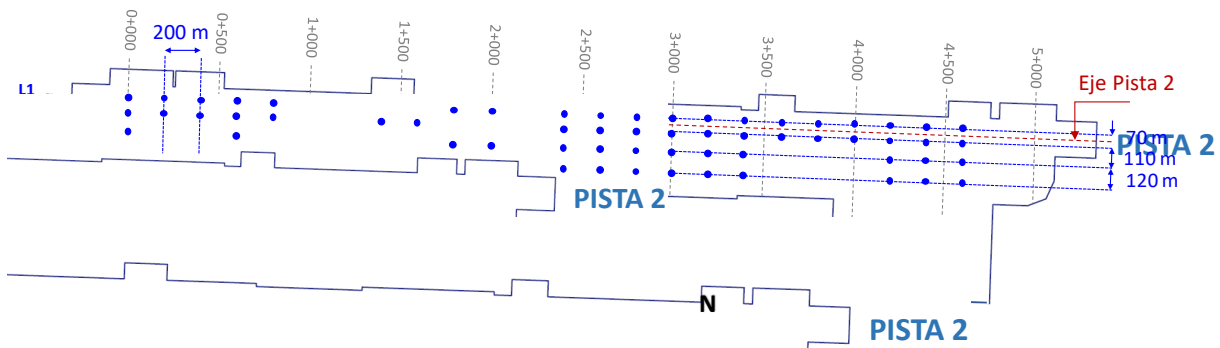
Ubicación en planta de pozos de bombeo con separación transversal de 200 m en la Pista 2 del NAIM.
